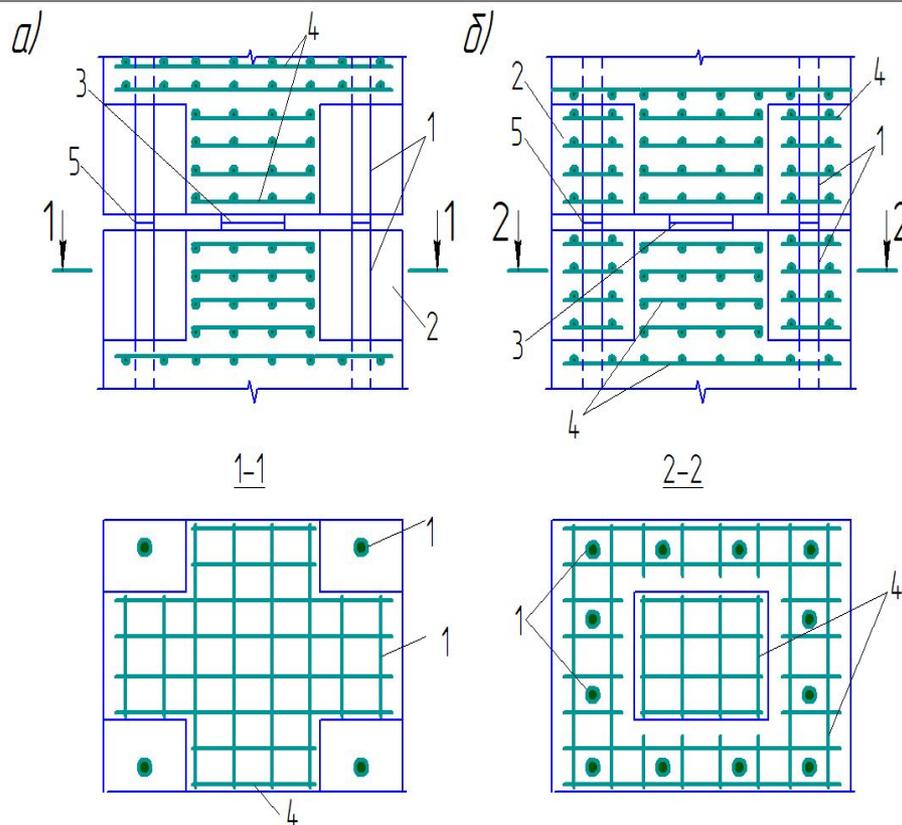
Жесткий стык сборных колонн с ванной сваркой арматурных выпусков
